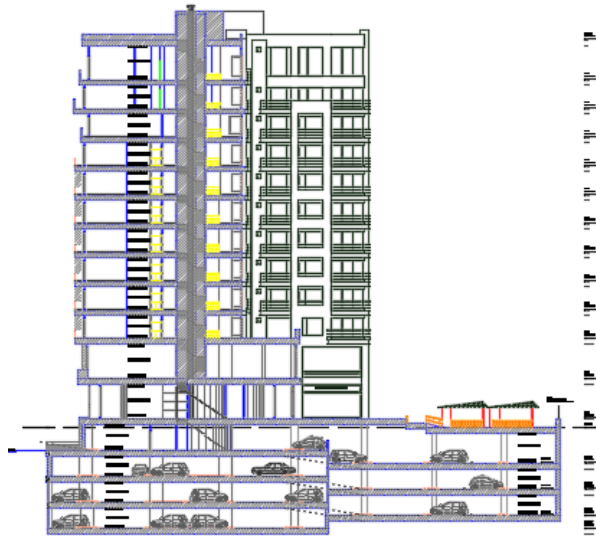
Corte Longitudinal Edificio Campestre Towers
